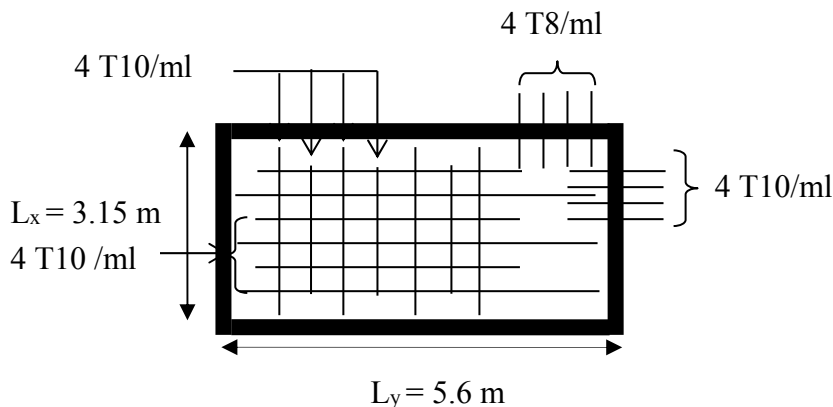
Schéma de ferrailage de la dalle sur 4 appuis
